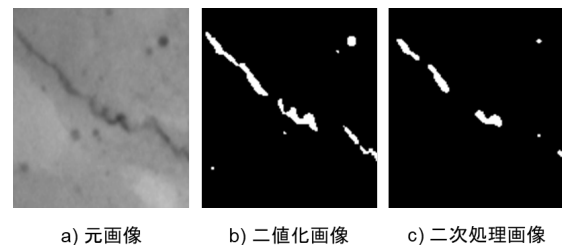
X線CT画像内のひび割れ抽出（従来）
